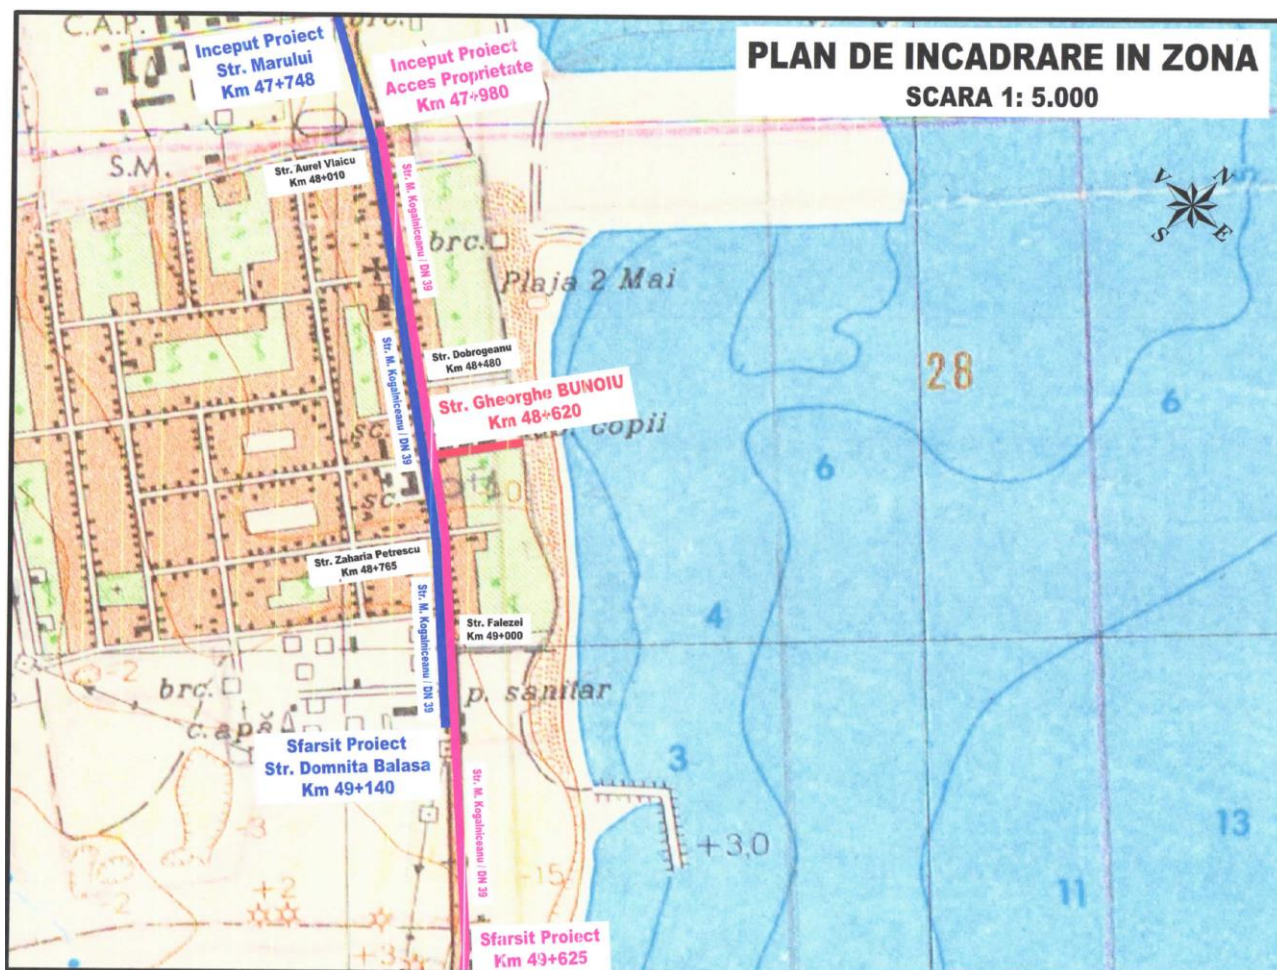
Plan de încadrare în zona teren studiat (conf plan intocmit de proiectant)
